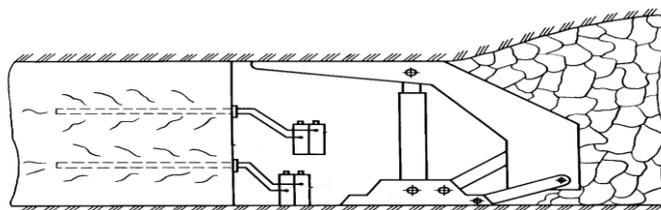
Схема крепления кровли с использованием нагнетаемого раствора
